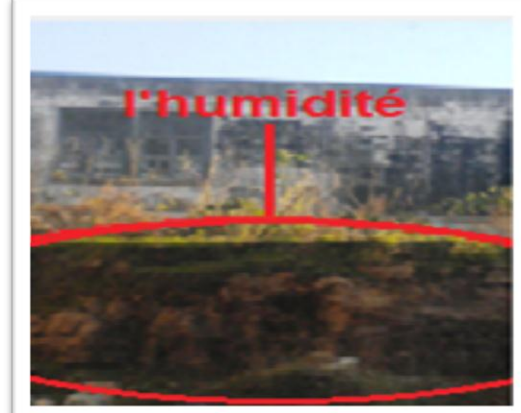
Caveau détruit à cause d'humidité. Source : Auteur.
